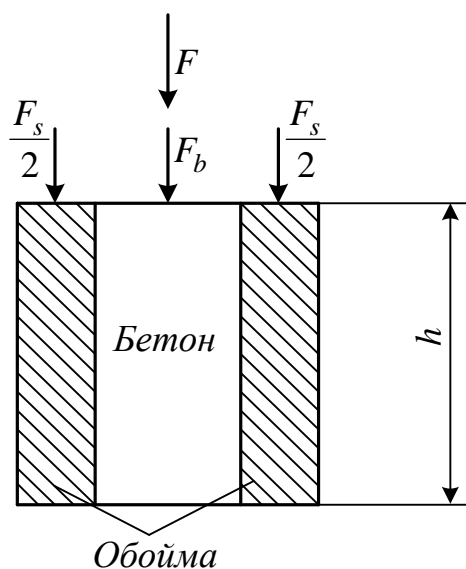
Навантаження, що діють на трубо бетонний елемент
